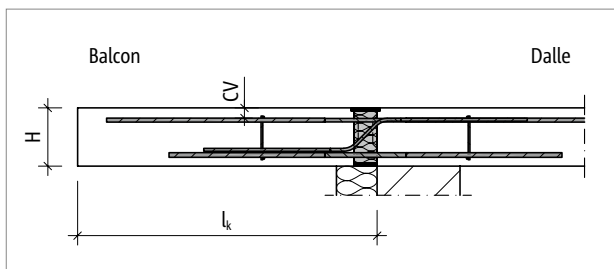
Schöck Isokorb® T types K-M13 et M14 : système statique
